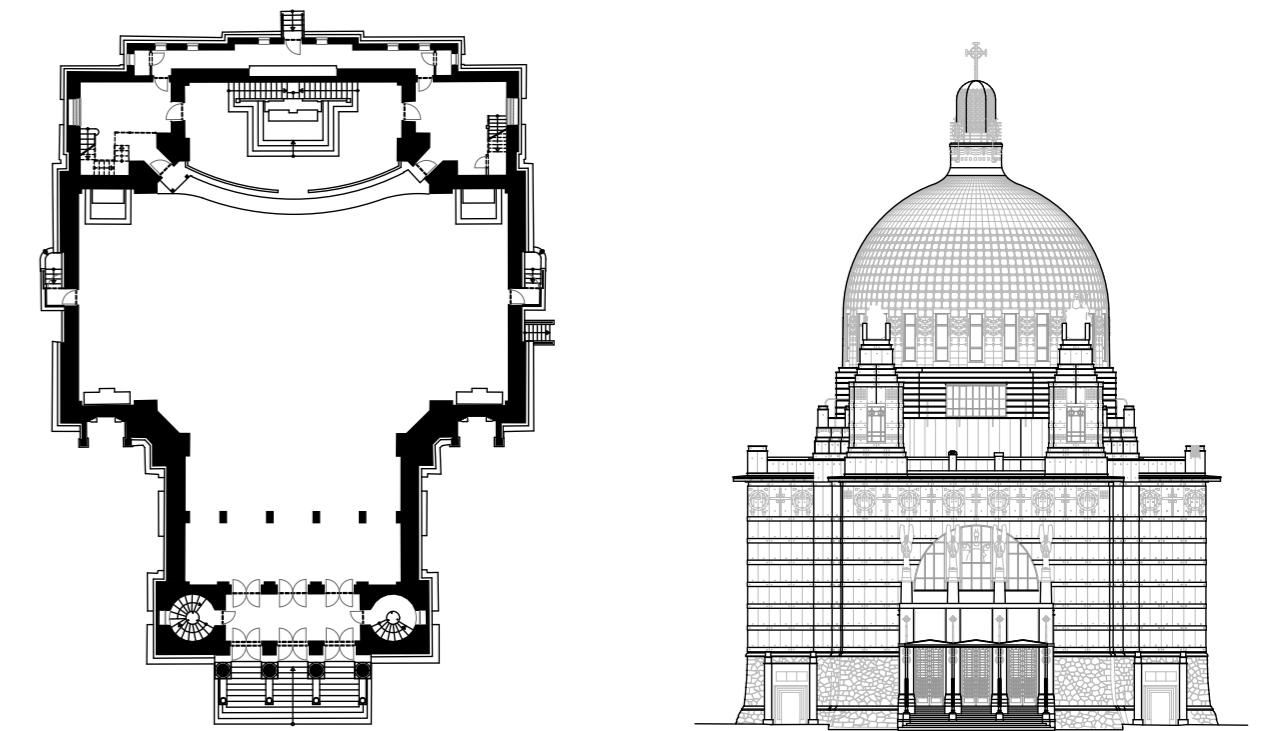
Bestandsplan Kirche | Erdgeschoss - Ansicht Süd | M 1-500
